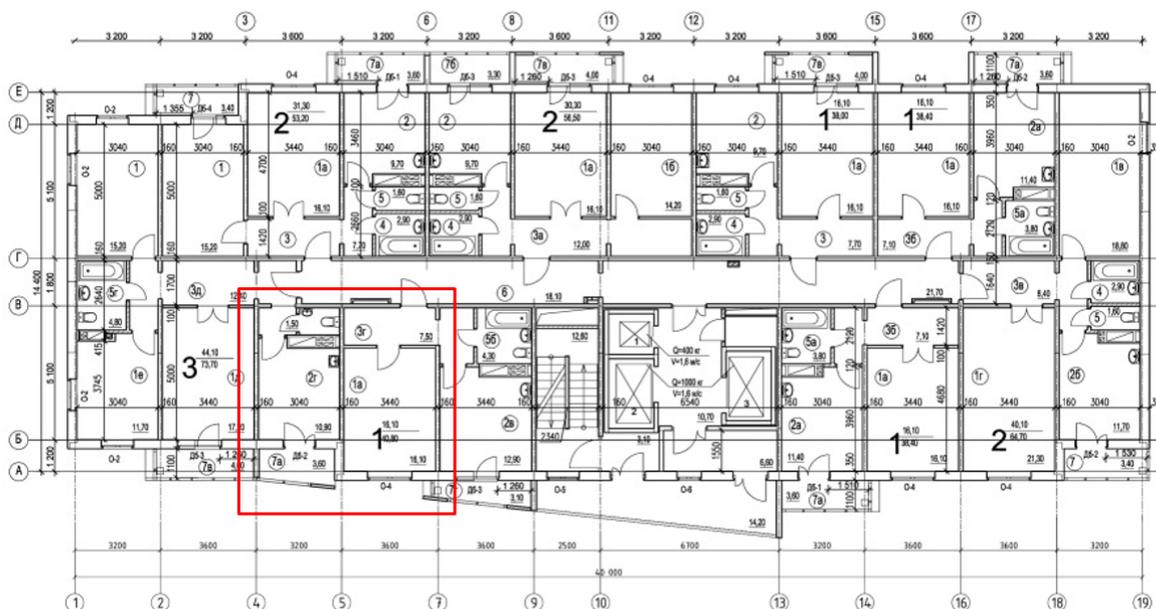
План первого этажа (рамкой выделены наиболее нагруженные ячейки)
